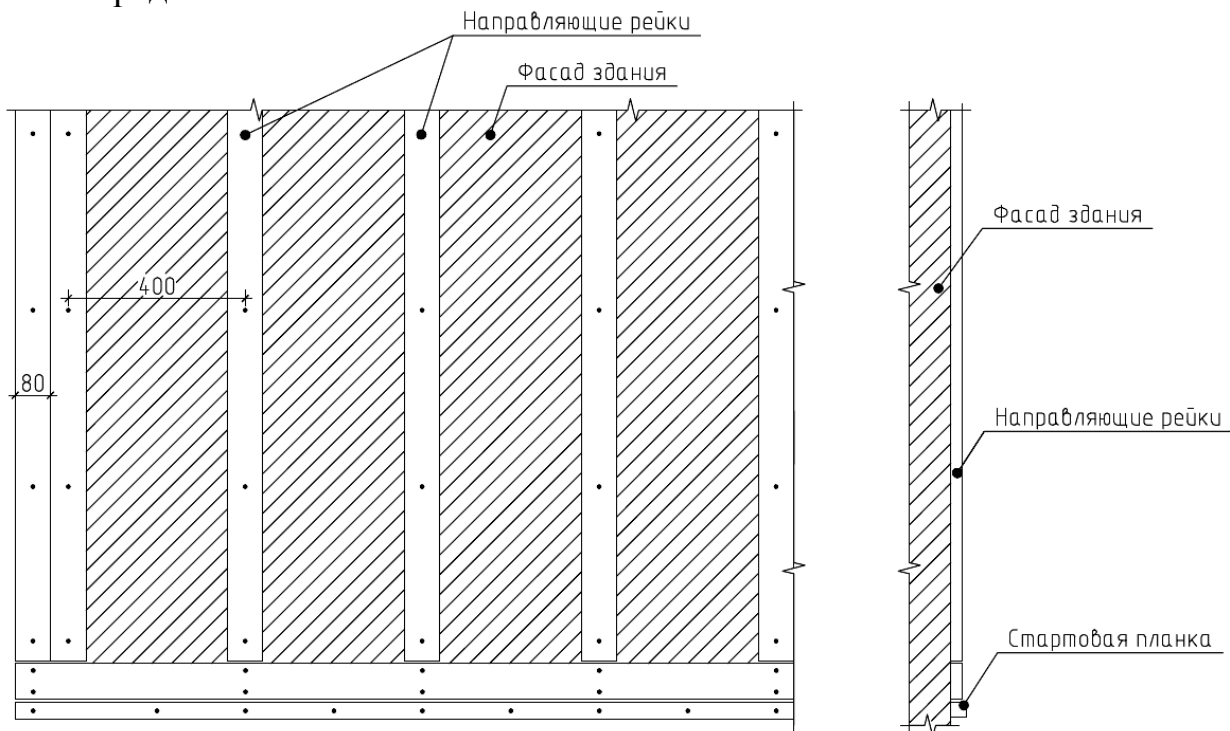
схема установки стартовой планки и направляющих для сплошной стены
